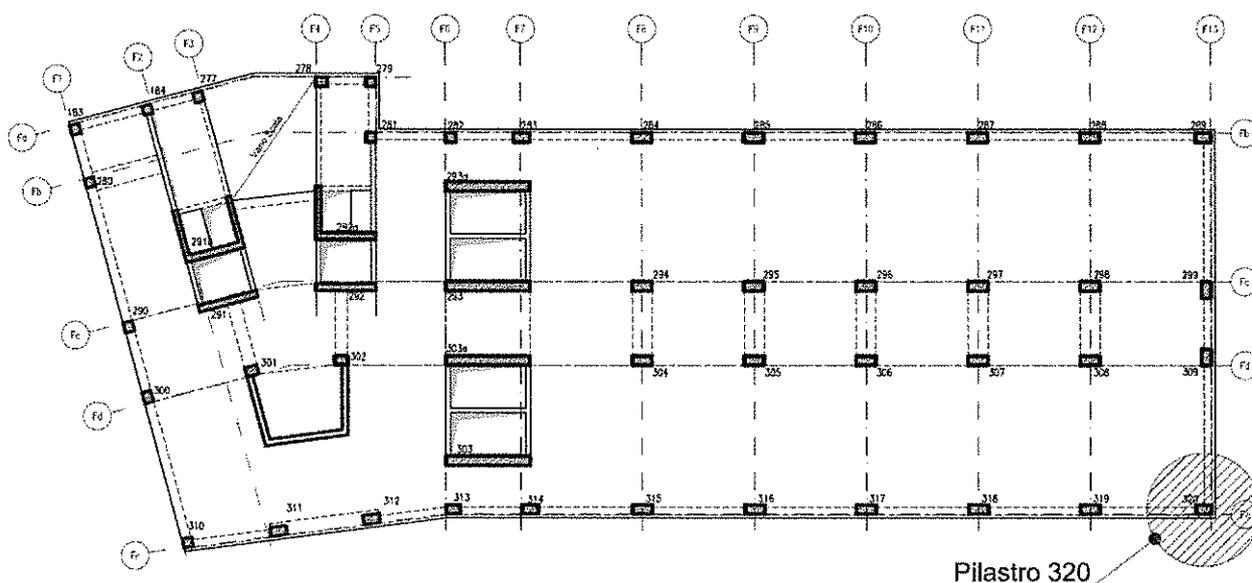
Edificio F – Pianta a livello 2 – Ubicazione pilastro 320.
